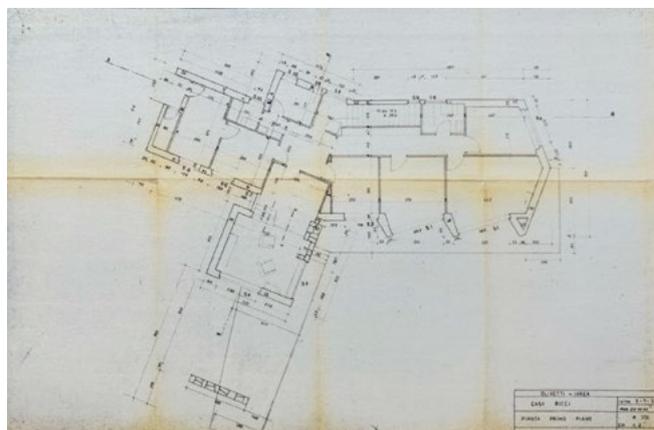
Pianta di casa Ricci (Associazione Archivio Storico Olivetti, Fondo Tarpino).
